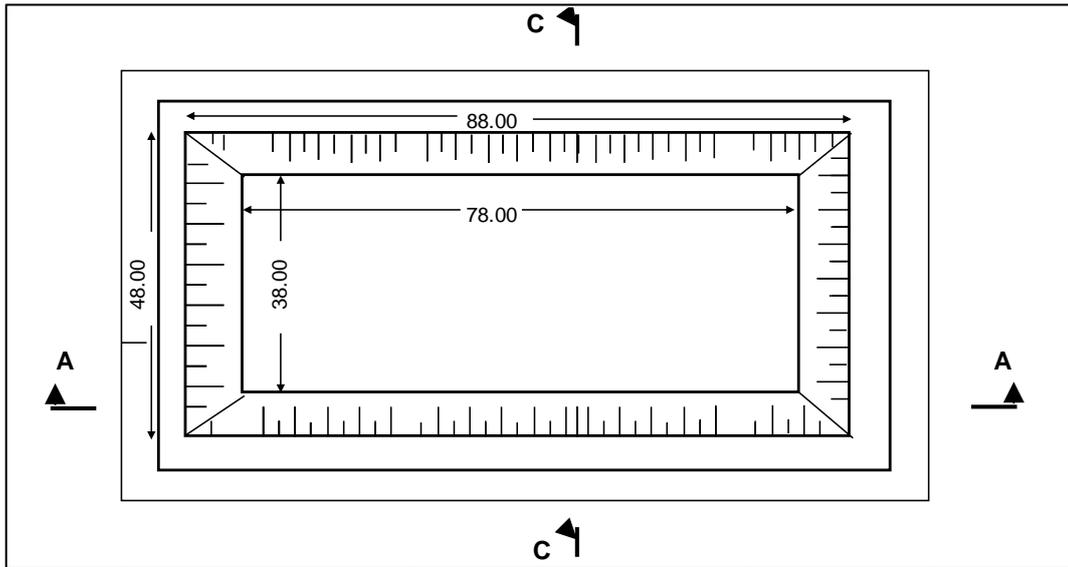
Dimensionamiento en planta de la laguna de oxidación primaria.
